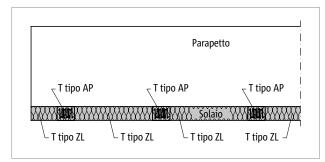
Schöck Isokorb $^{\circ}$ T tipo AP: disposizione orizzontale, parapetto anteposto
